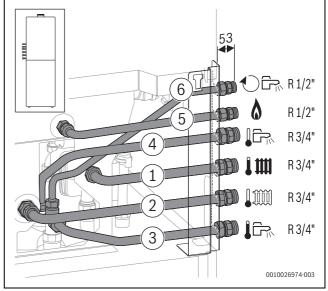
Vue côté arrière (dimensions en mm) : accessoire CS 10 monté sur le côté gauche
